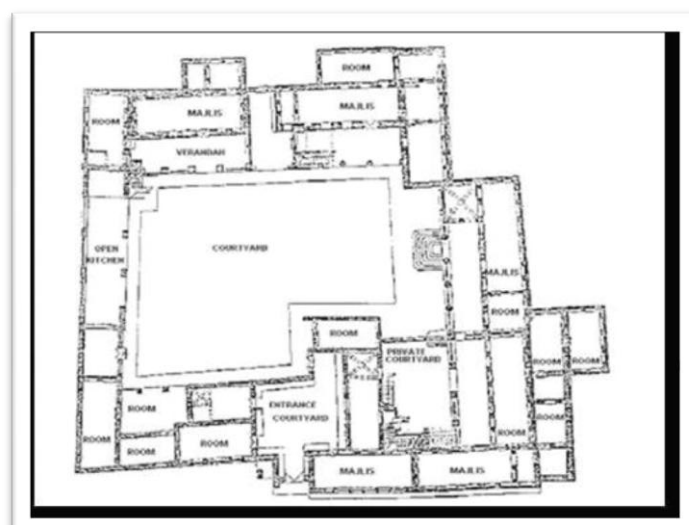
Plan d'un habitat antique organisé autour d'une cour intérieure, caractéristique des constructions méditerranéennes anciennes. [9]
